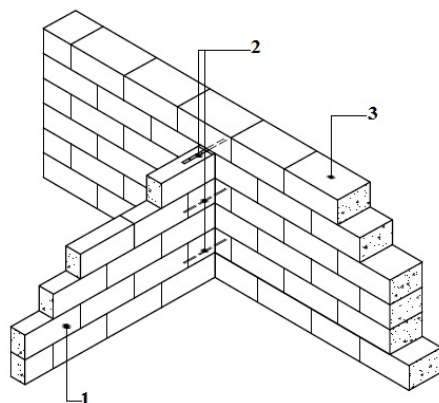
Сопряжение кладки наружной и внутренней стен из газобетонных блоков:
